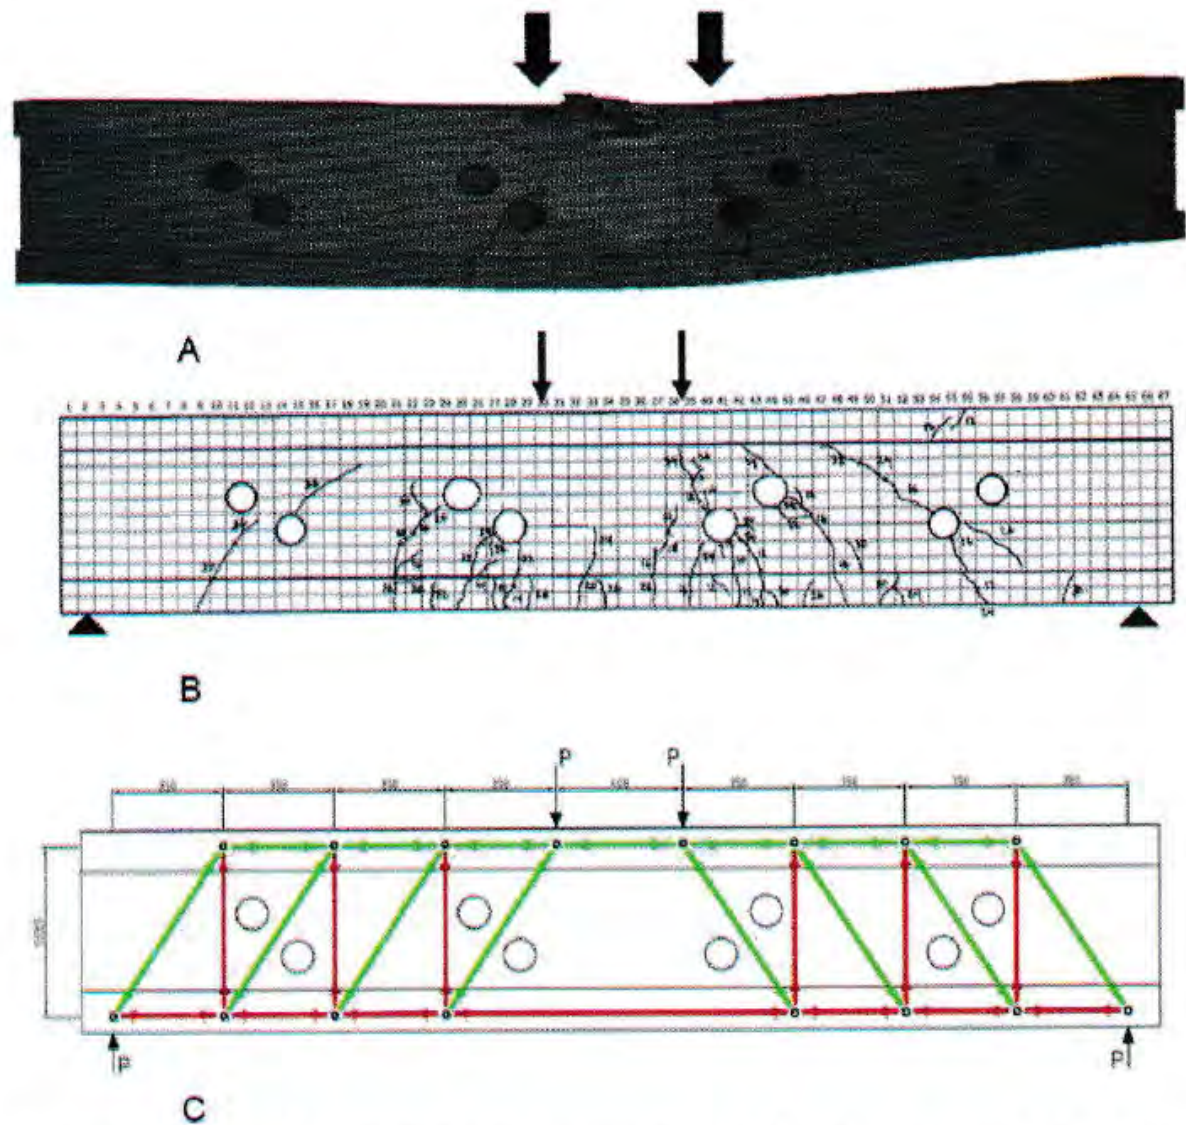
Truss analogi untuk balok beton bertulang sesuai Mörsch
